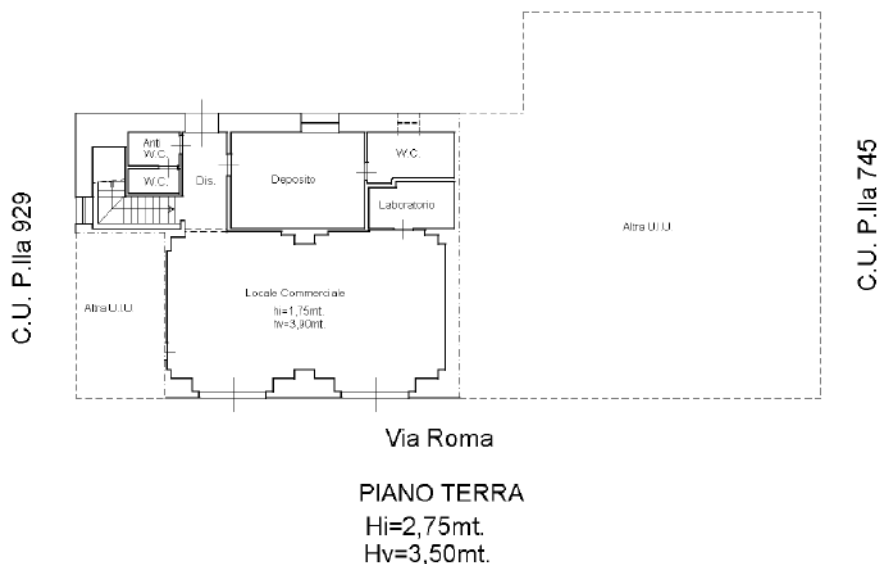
PLANIMETRIA IN ATTI CATASTALI PIANO TERRA - CONFORME
